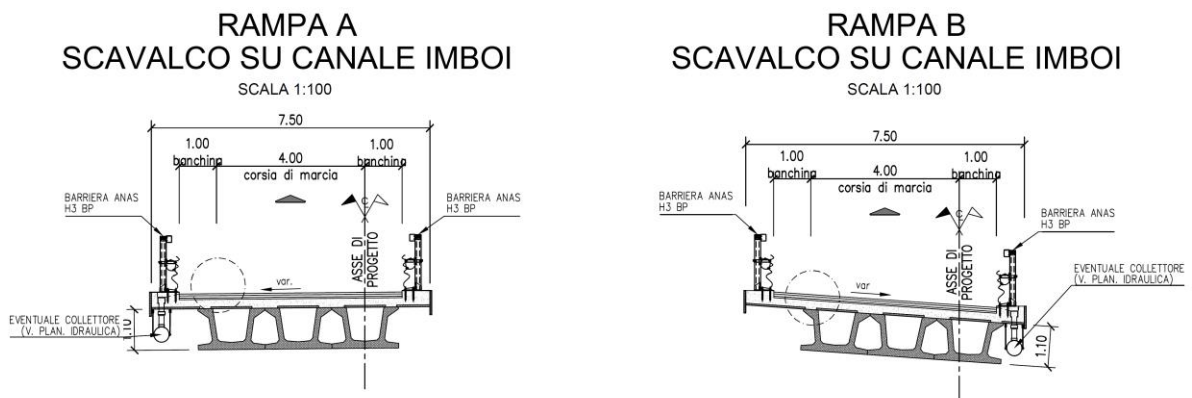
Sezione tipo Rampa A e B su Scavalco canale IMBOI
